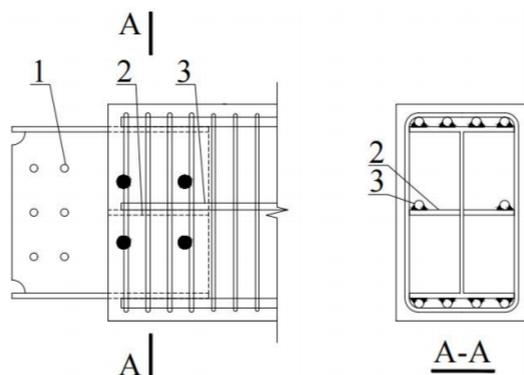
预制梁纵向抗扭钢筋与梁端钢组件连接构造
